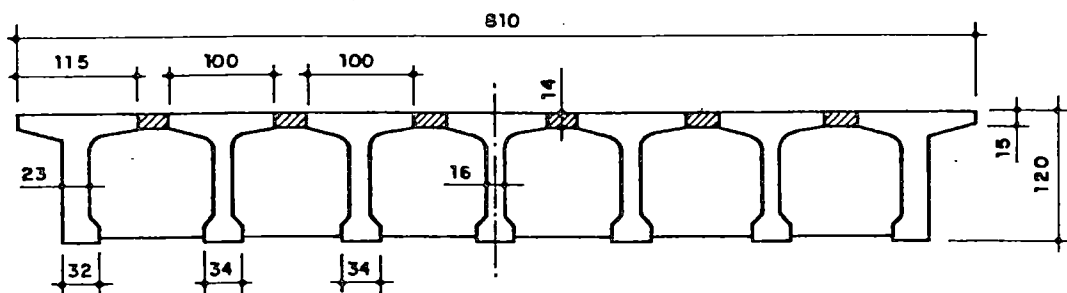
FORMAÇÃO DE SEÇÕES TRANSVERSAIS EM VIGAS "T" PRÉ-MOLDADAS
